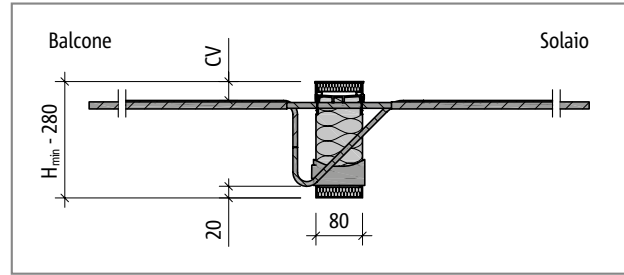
Schöck Isokorb® tipo K70M - K110M, sezione del prodotto
